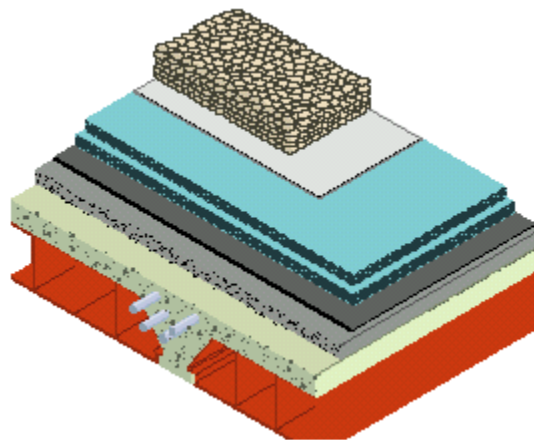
Detalle del orden de colocación de los diferentes elementos en la cubierta plana invertida. Colocación del aislamiento térmico sobre la impermeabilización. En este caso se termina la cubierta, con la colocación de un geotextil de gramaje adecuado, y grava seleccionada.
